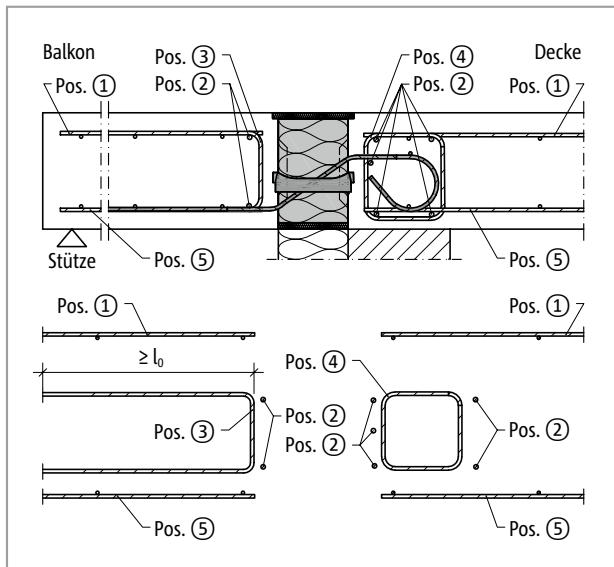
Schöck Isokorb® XT Typ Q-V1 bis V4 Bauseitige Bewehrung
